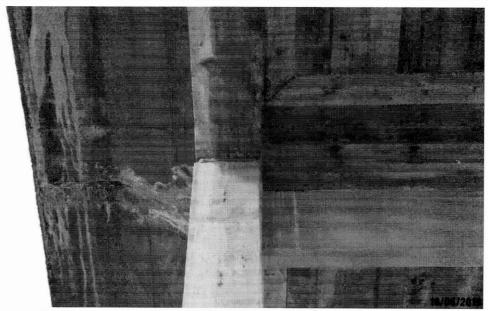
Detalhe de armadura exposta, eflorescência e infiltração na face inferior do tabuleiro.
